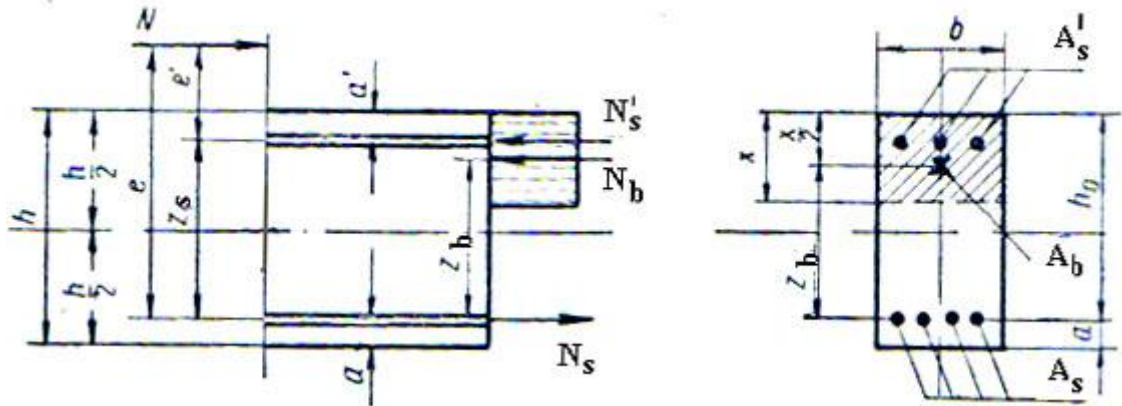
Розрахункова схема позациентрово стиснутого елемента (випадок 1)
